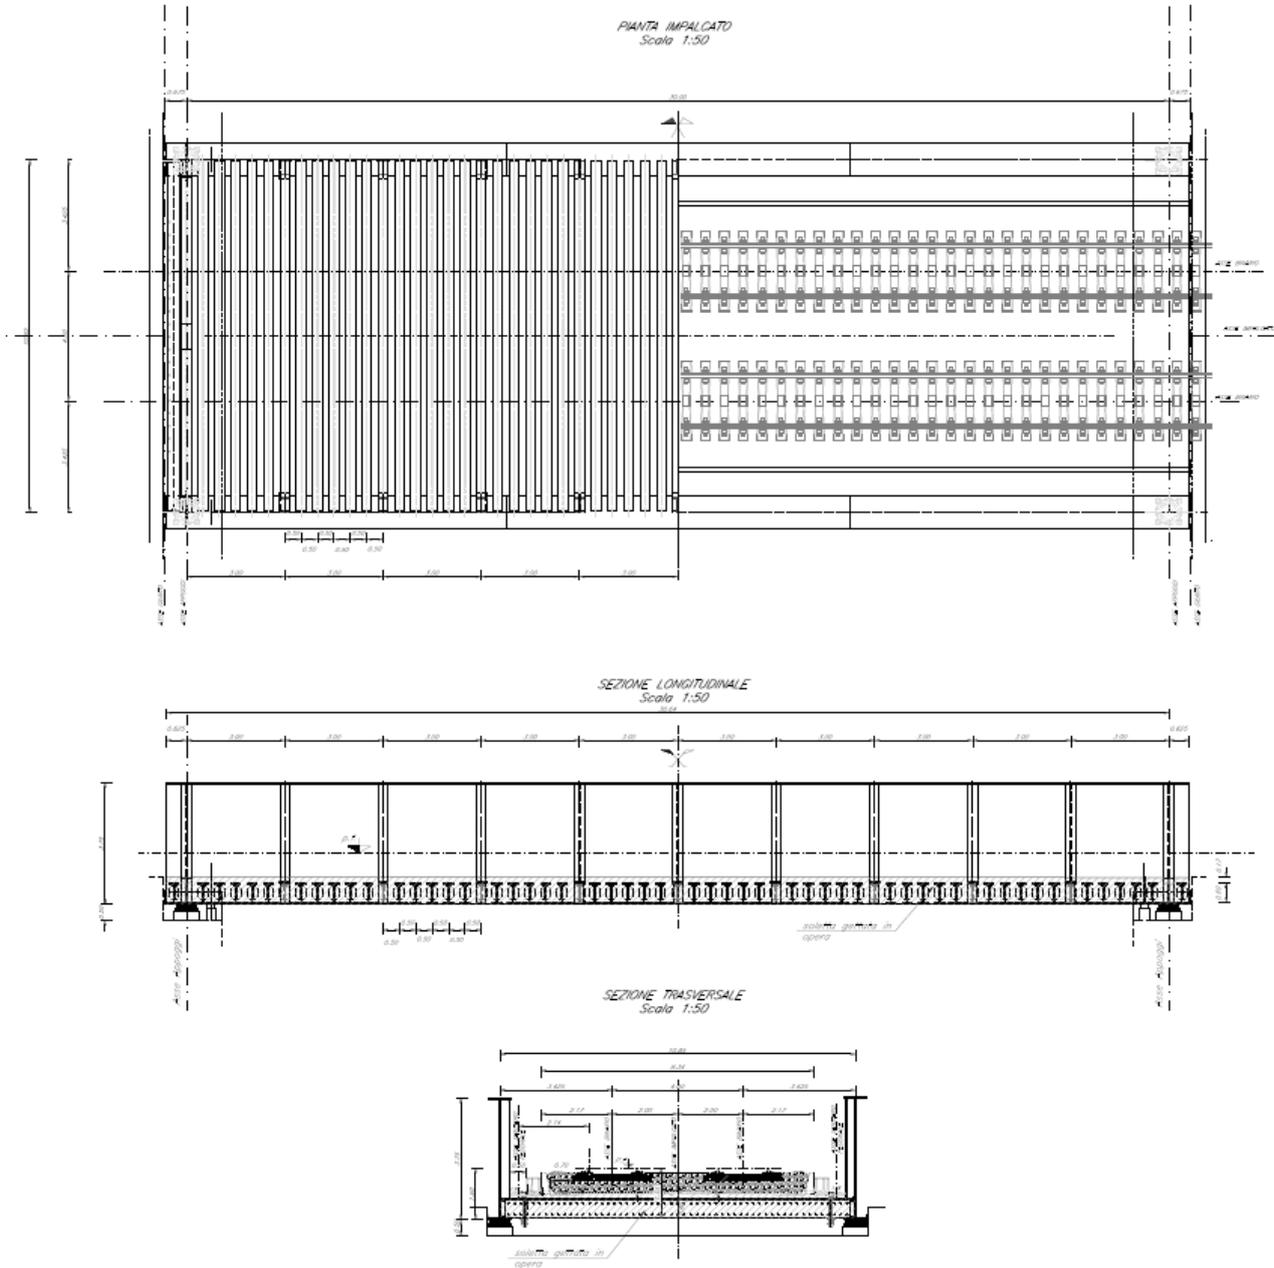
Impalcato a parete piena a via inferiore – L=30.00 m – doppio binario
